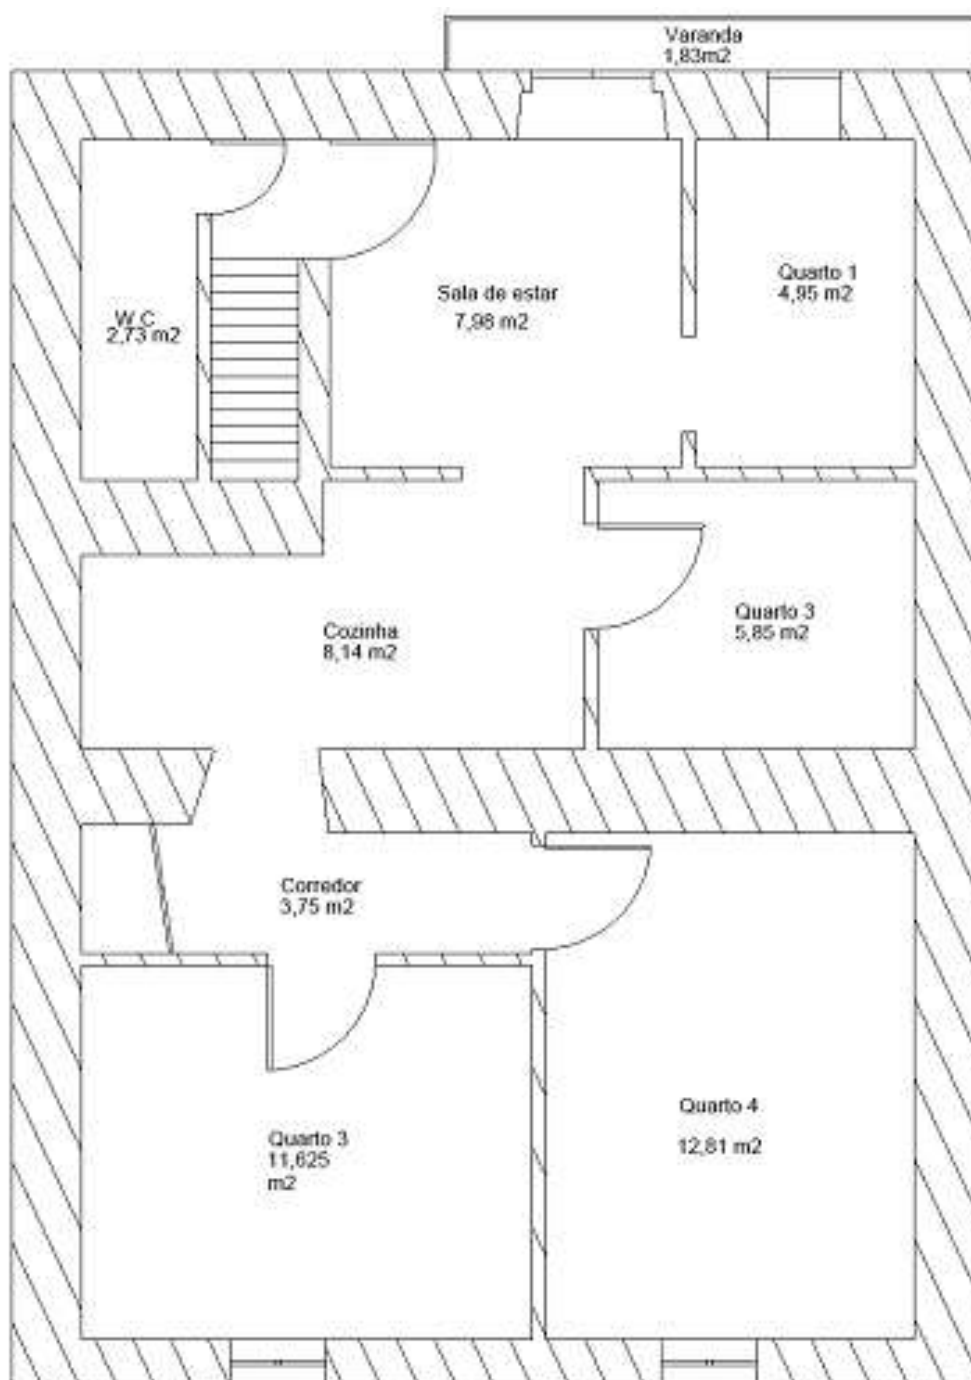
Planta de levantamento (fonte: Vander Costa, 2025)
